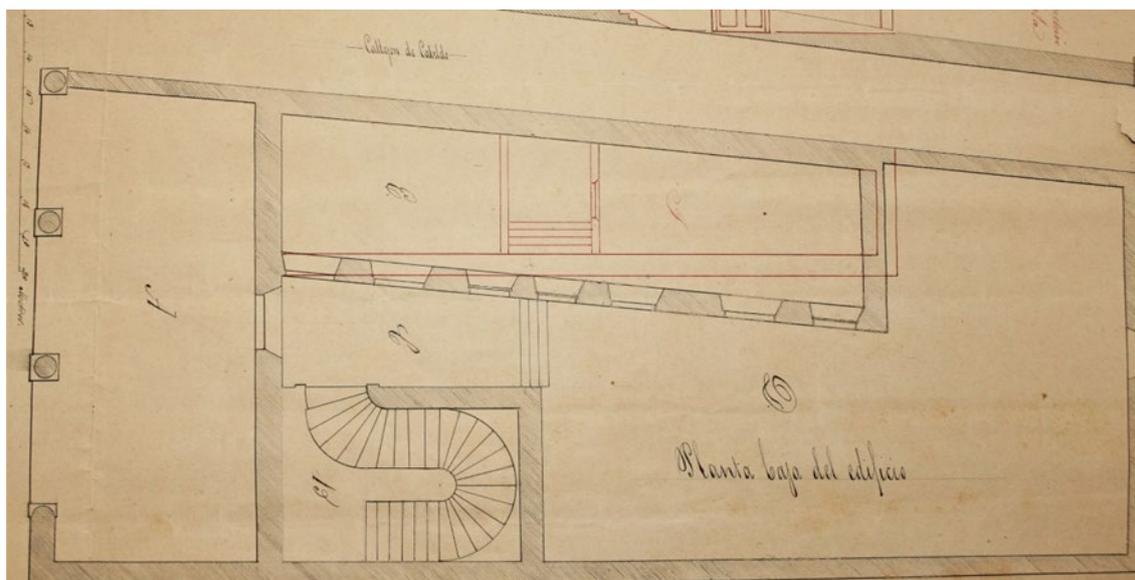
Plano del atrio y planta baja del ayuntamiento con escalera de acceso a la primera planta, en 1837.
